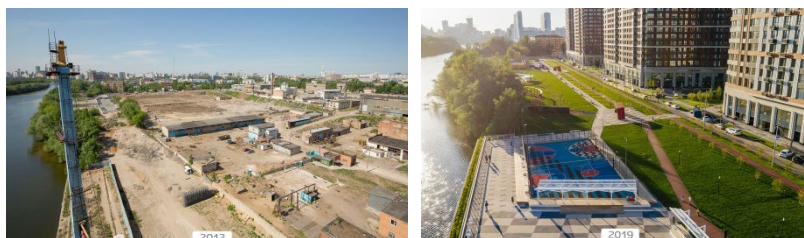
Реновация набережной на месте бывшего завода железобетонных конструкций № 355 и асфальтобетонного завода № 1, г. Москва
